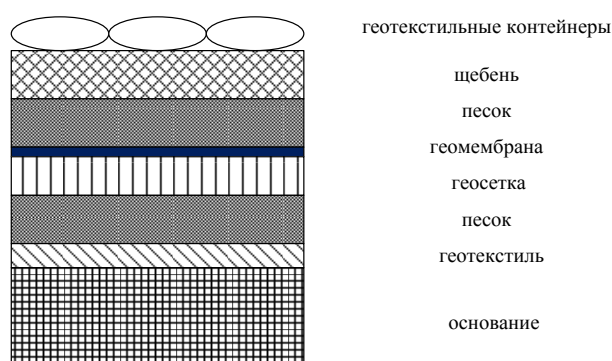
Возможный вариант схемы исполнения гидроизоляционного экрана площадки под размещение геотекстильных контейнеров на слабом основании
